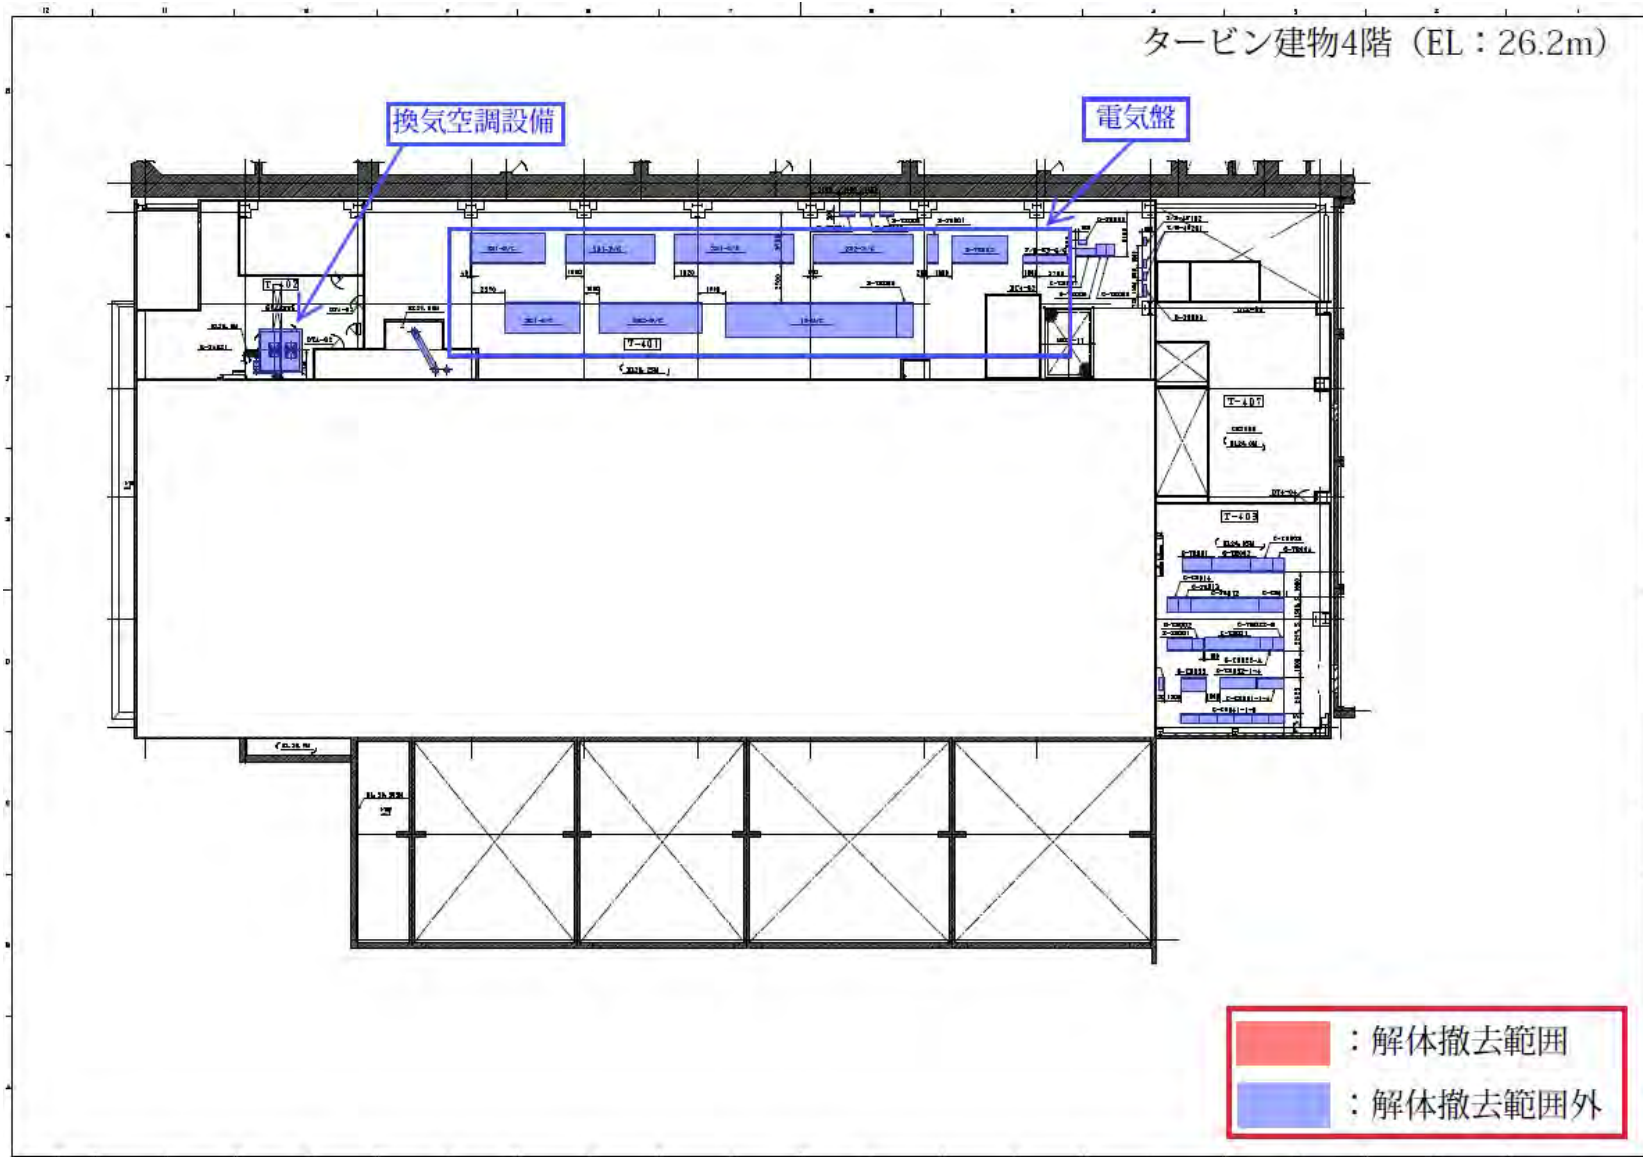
主な解体撤去機器 (タービン建物平面図) (3/7)
